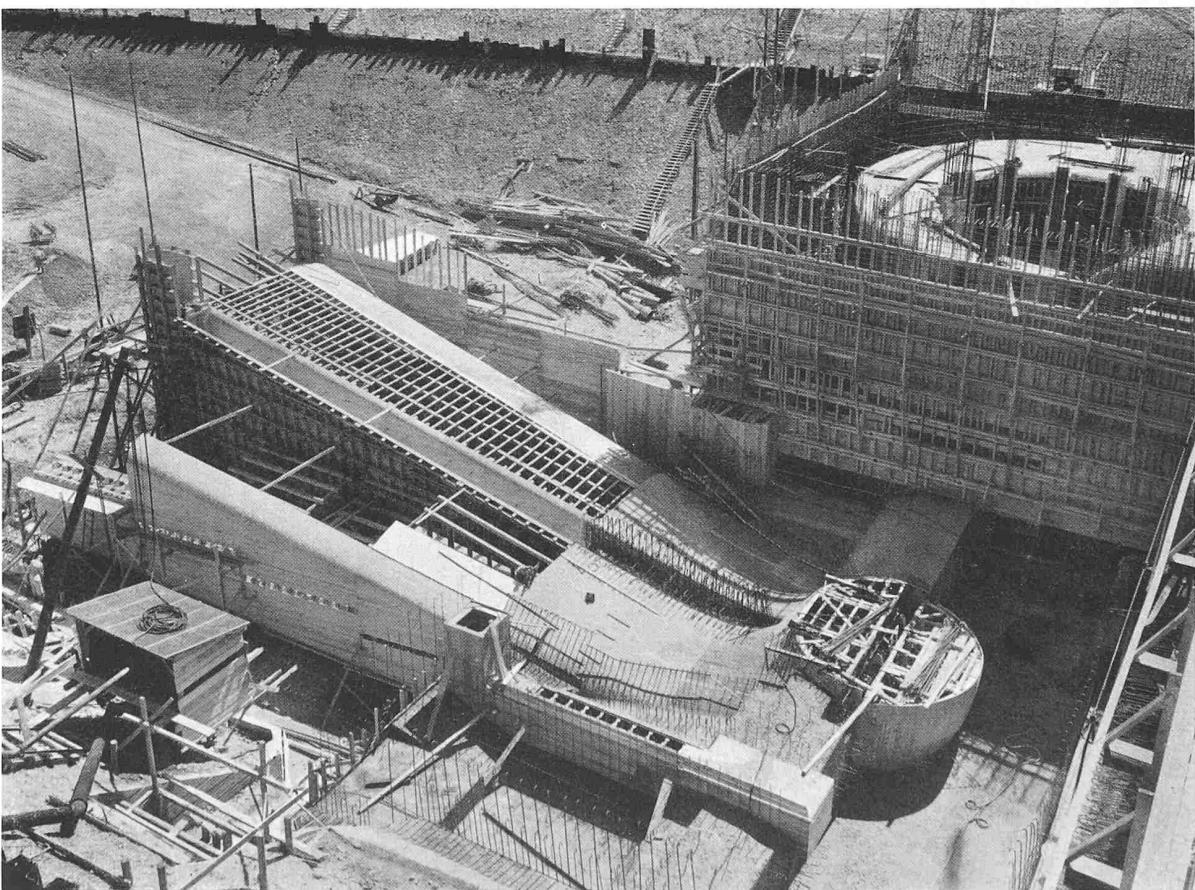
Maschinenhaus. Schalung des Saugrohres der Maschinengruppe 1. 23. August 1950
